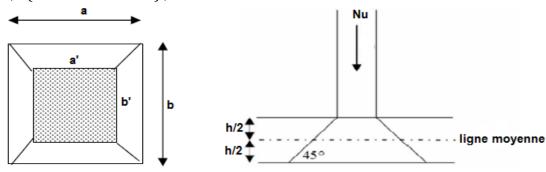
Schéma de transmission des charges sur le radier sous poteau.
